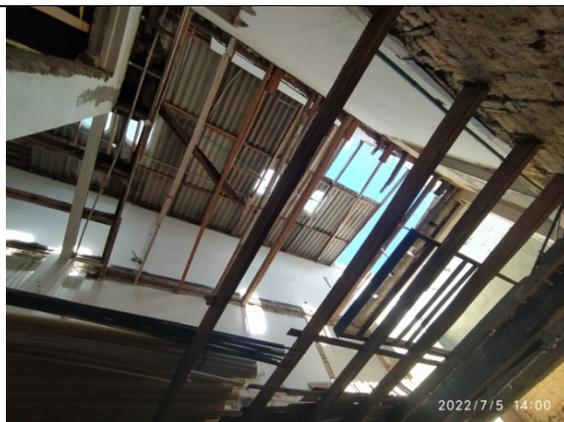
Estado actual de un espacio en primer y segundo piso, se pueden ver en cubierta algunas intervenciones anteriores.
